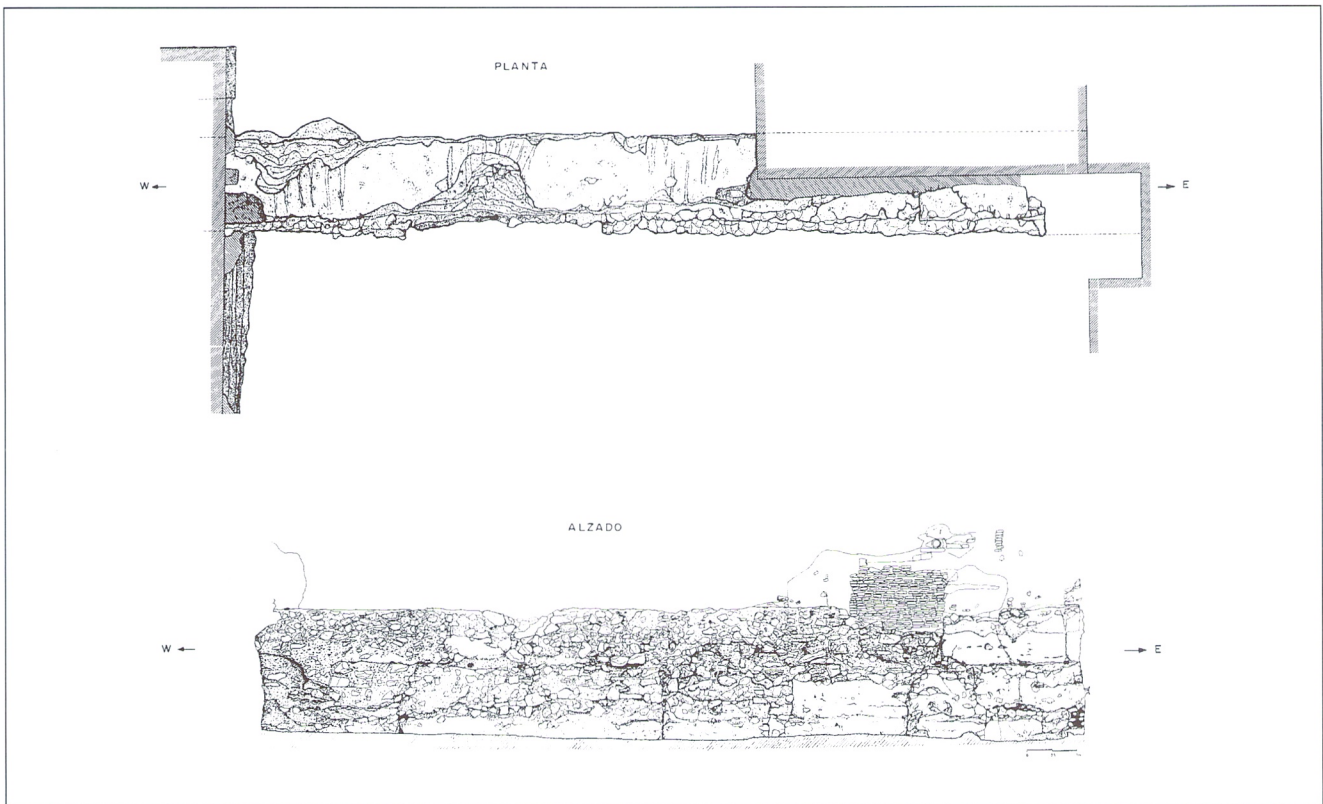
MURALLA, LIENZO 1: PLANTA Y ALZADO EXTERIOR.
